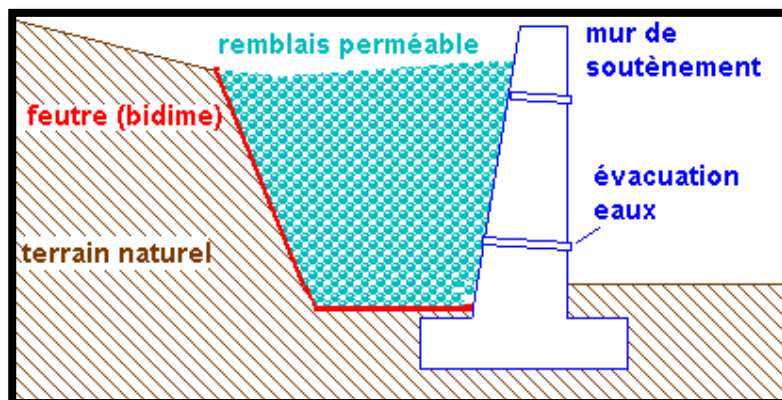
Détail d'un voile en béton armé . Source : <http://www.ideesmaison.com/Construction/Gros-travaux/Pose-d-un-mur-de-parpaings/Le-mur-de-soutènement.html>
